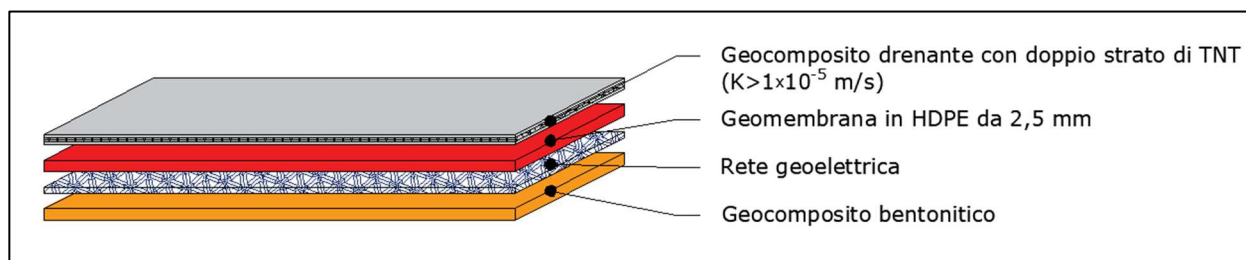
/XX: Pacchetto impermeabilizzazione e drenaggio
